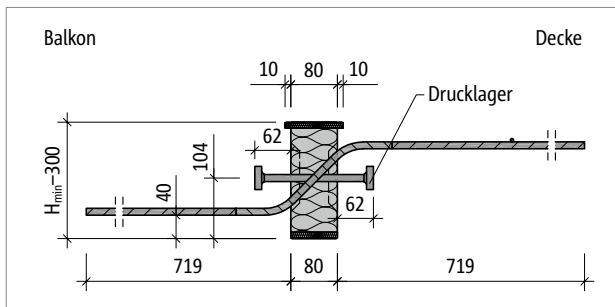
Schöck Isokorb® T Typ QP-V7: Produktschnitt
